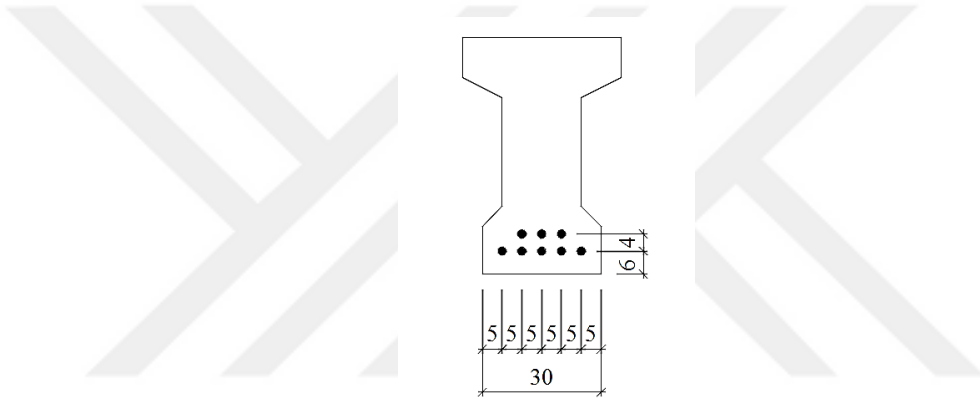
Öngermeli kiriş açıklık ortasında en kesit ve ölçüleri
